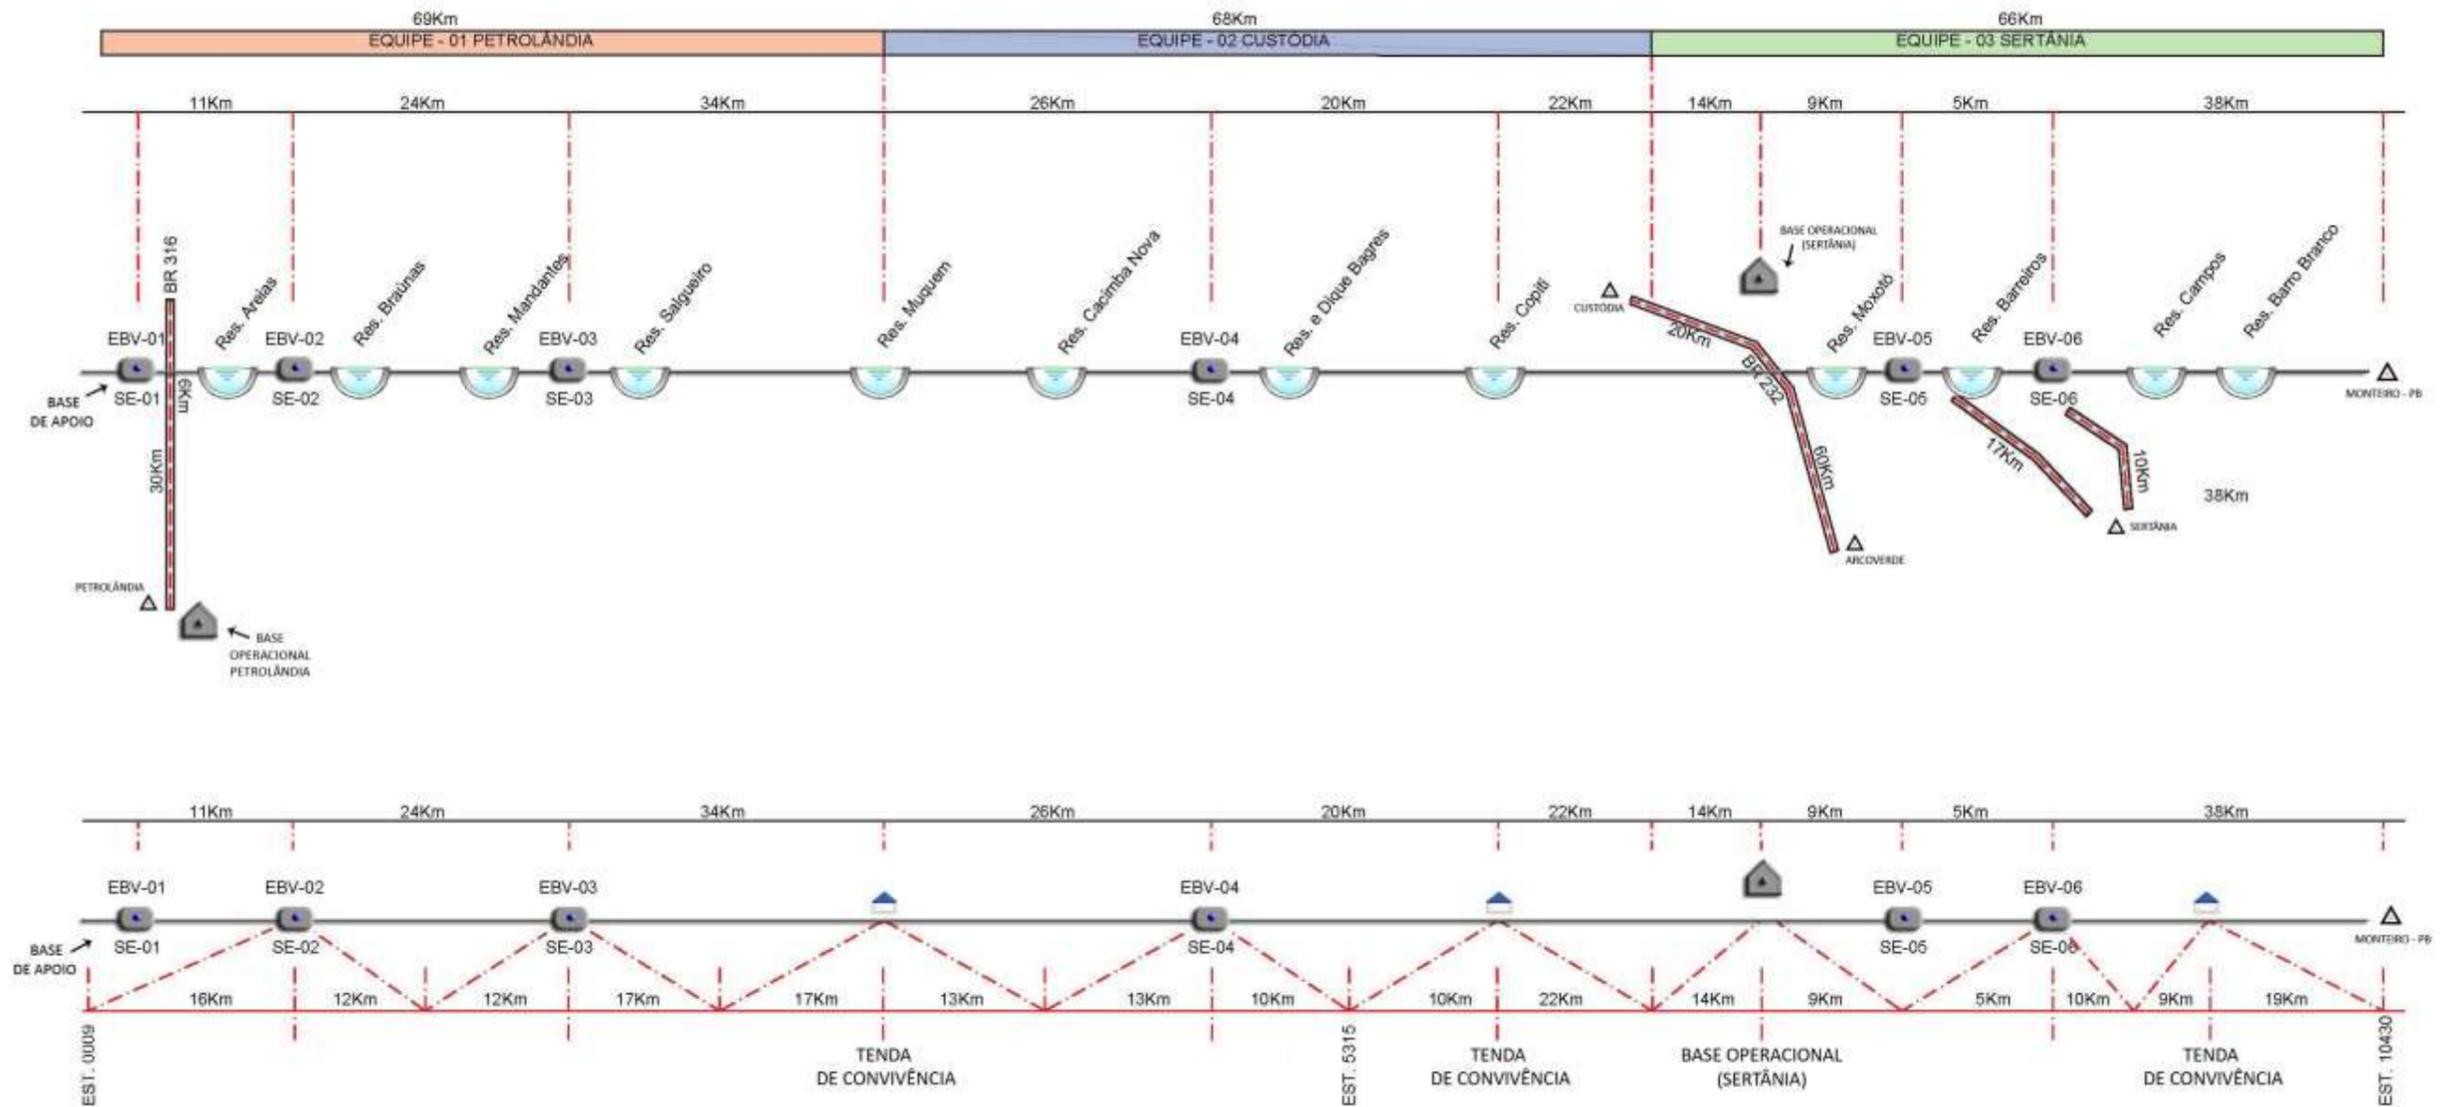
Plano de Logística – Pontos de Apoio, Tendas e Canteiros
